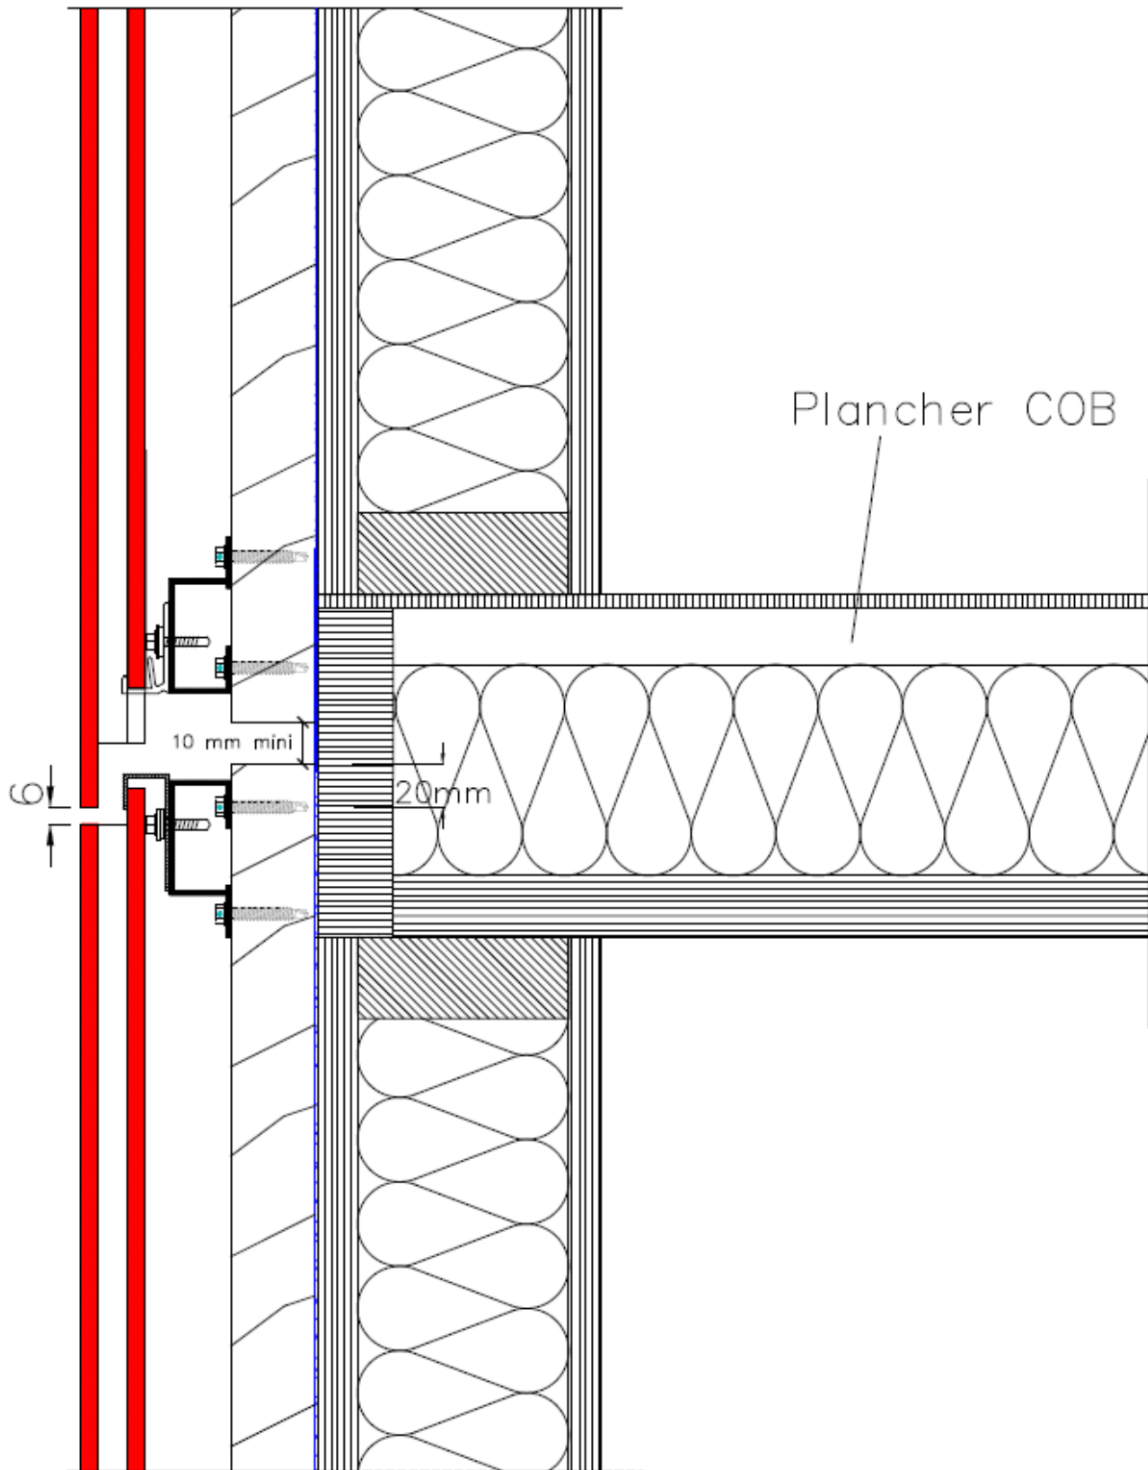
Fractionnement de l'ossature à joint fermé au droit de chaque plancher sur COB/CLT
